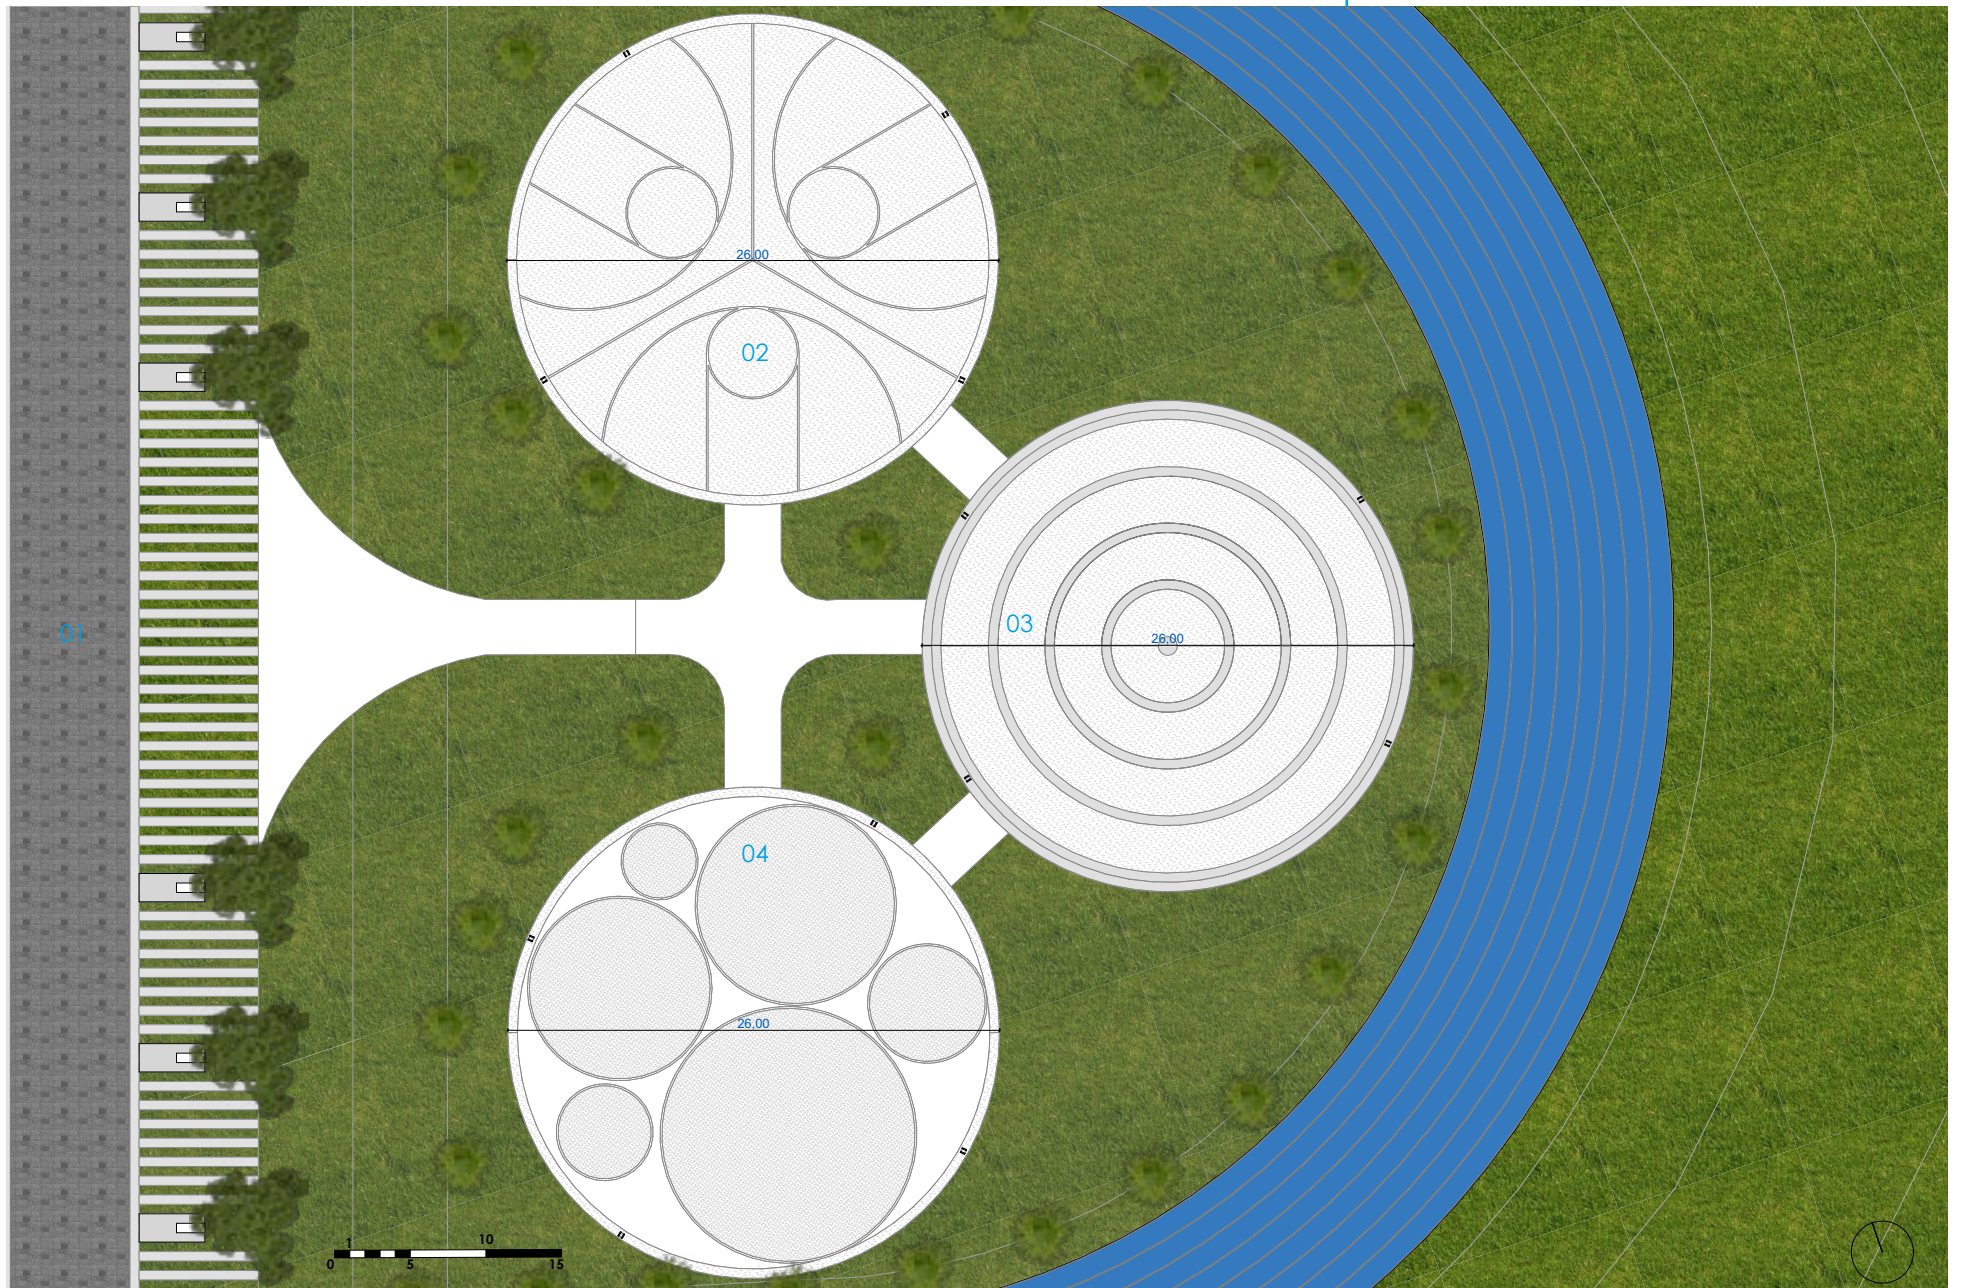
| Planta recreación n. -1,50 m, bloque C, proyecto arquitectónico. | Elaboración: Propia
